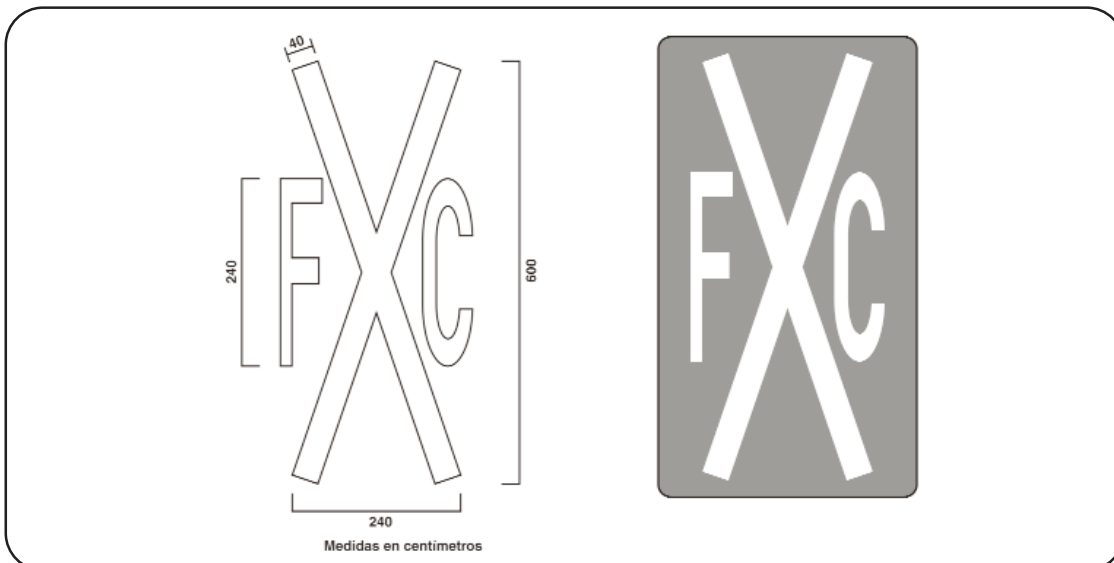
Demarcación en el pavimento para señalar los pasos a nivel
